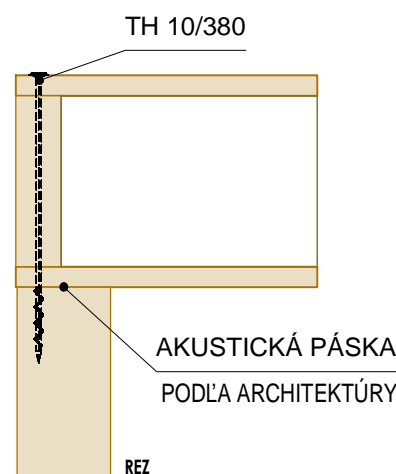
DETAIL "H" - PRIPOJENIE STROPNÉHO PANELU A BETÓNOVÉHO JADRA
